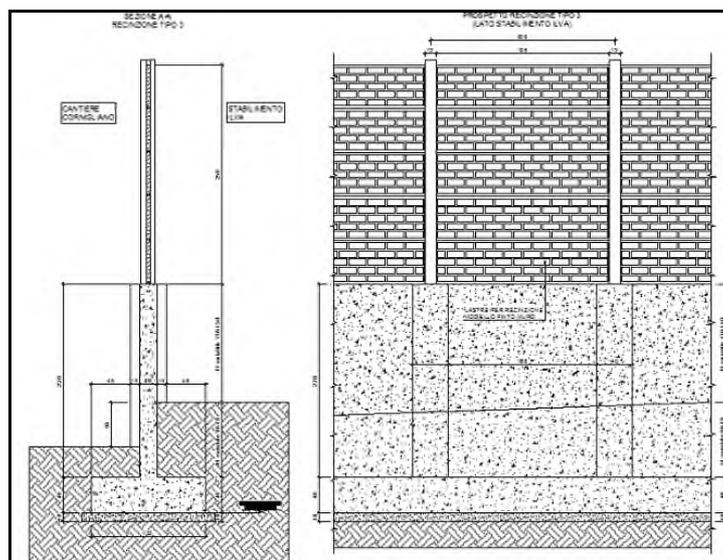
Stralcio dell'elaborato grafico 055/PES/6.03/T018 Progetto stradale - Recinzione.
